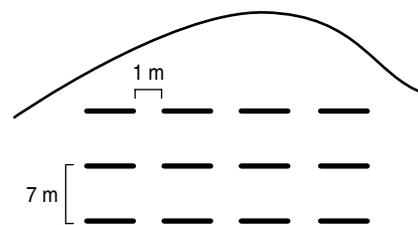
Distancias de construcción de las zanjas de infiltración en terreno.
